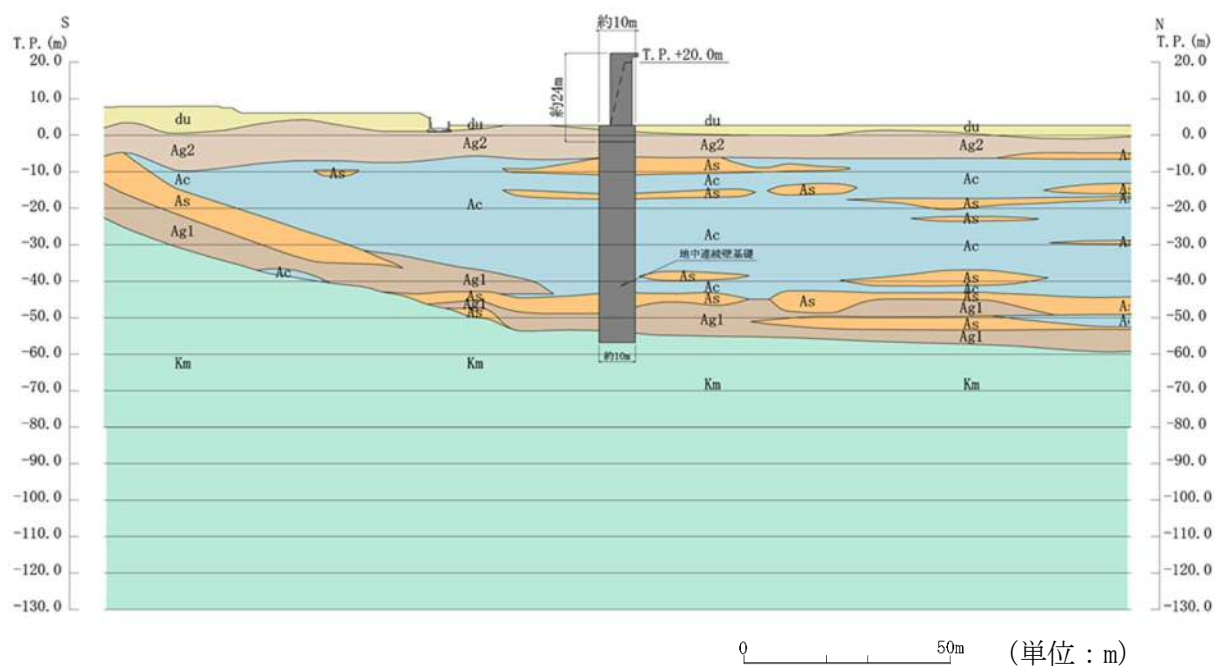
鉄筋コンクリート防潮壁の評価対象断面位置図
